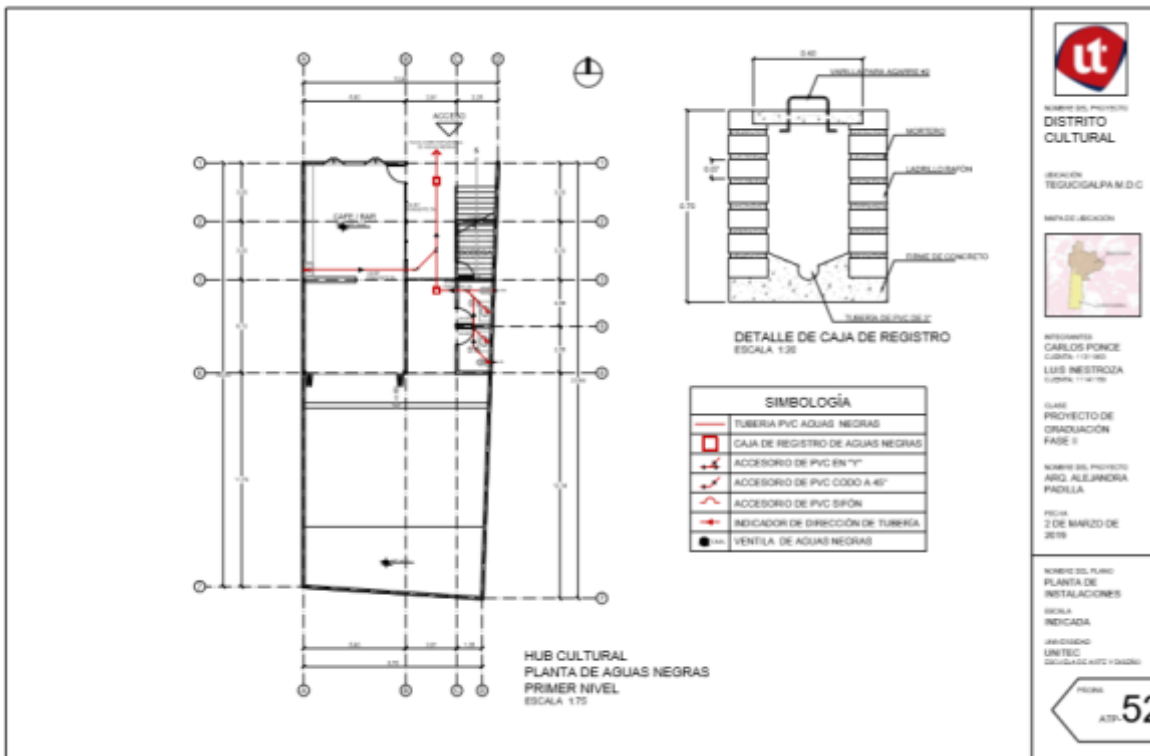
Planta de Aguas Negras Hub Cultural
